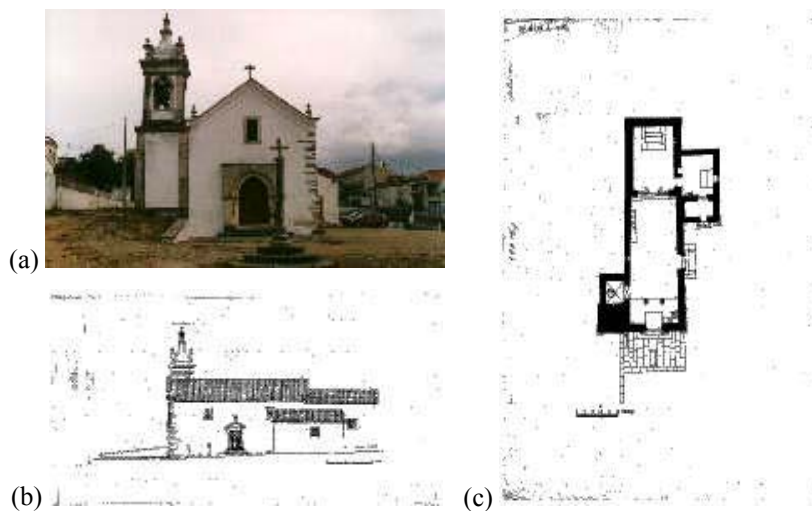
Peças desenhadas [DGEMN]: (a) fotografia da fachada; (b) alçado lateral direito; (c) planta.
